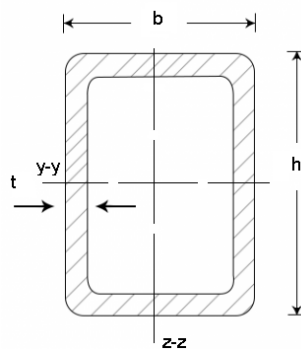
Secção transversal dos pilares (RHS 250x150x10)
